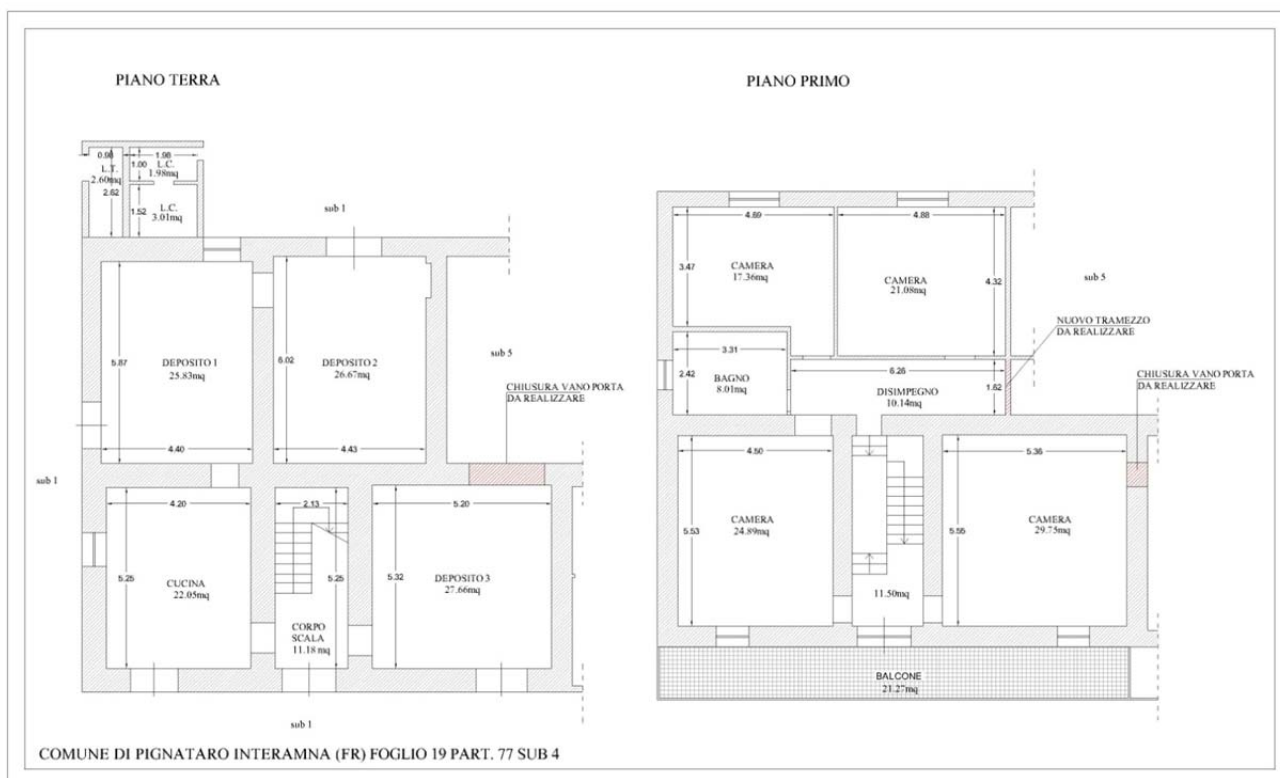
Piante della porzione di fabbricato nello stato rilevato
